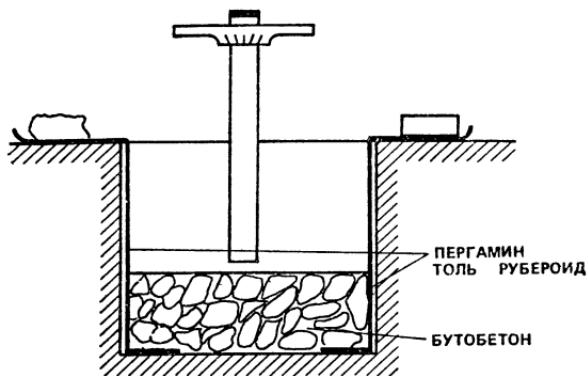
Устройство бутобетонных фундаментов в траншеях с вертикальными стенками
